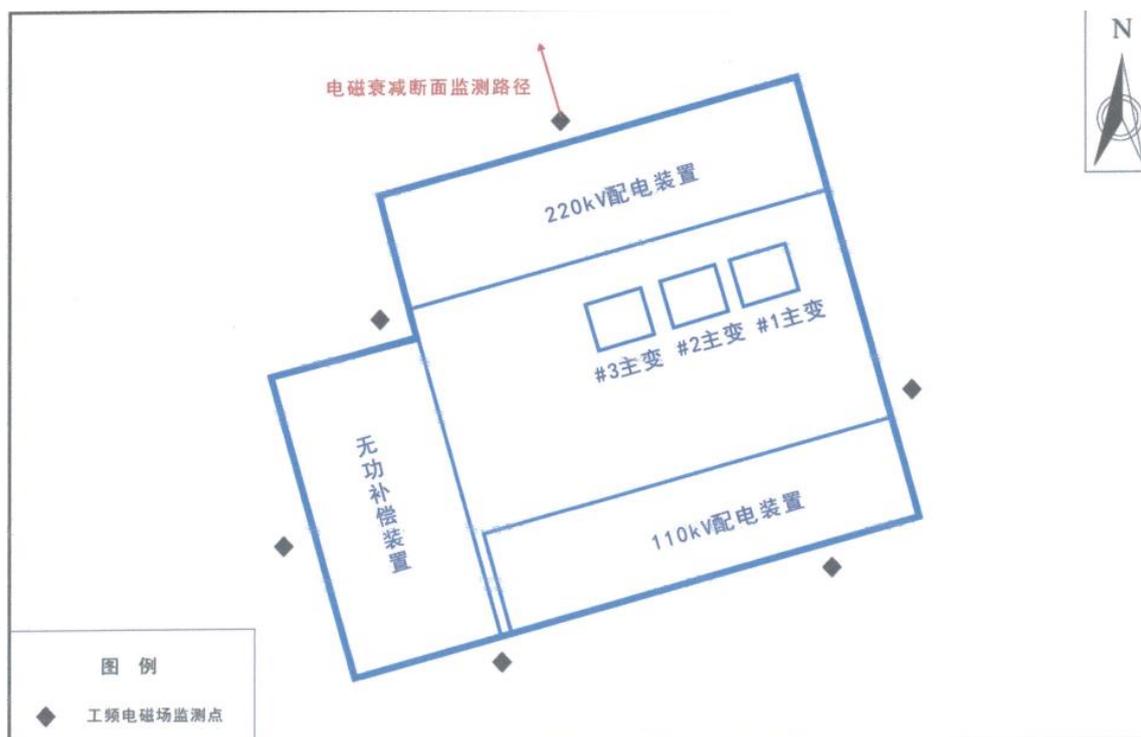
类比桥店变电站总平面布置及检测点位布置示意图
